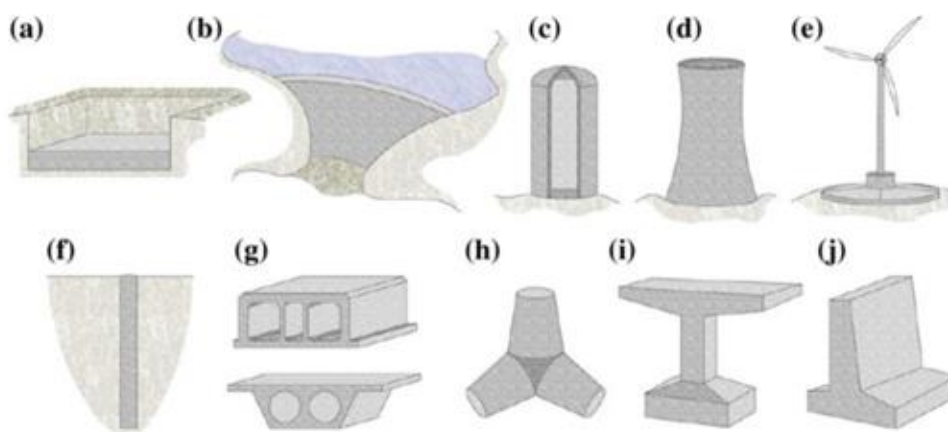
Exemplos de estruturas massivas de concreto a)lajes de fundação; b) barragens de concreto; c) silos / estruturas de contenção; (d) torres de resfriamento; (e) fundações de turbinas eólicas; (f) estacas; (g) segmentos pré-moldados; (h) blocos de tetrapodes; (i) mesoestruturas de obras-de-arte especiais; e (j) muros de contenção.
